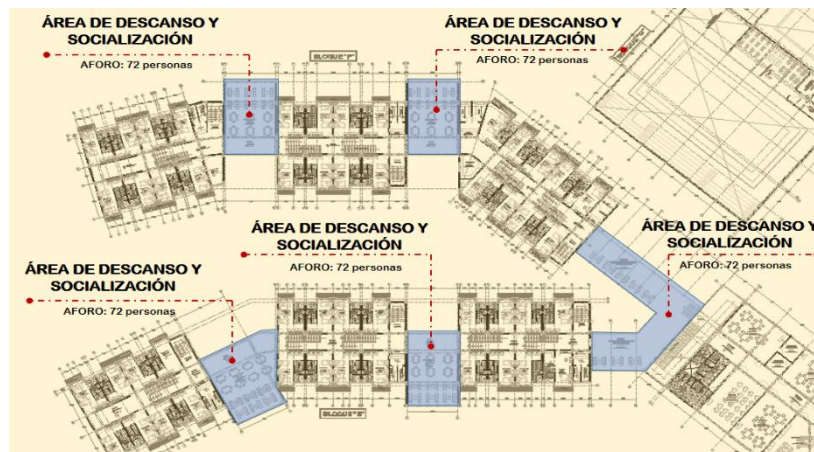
Vista en Planta - Espacios de estancia bloque residencial
